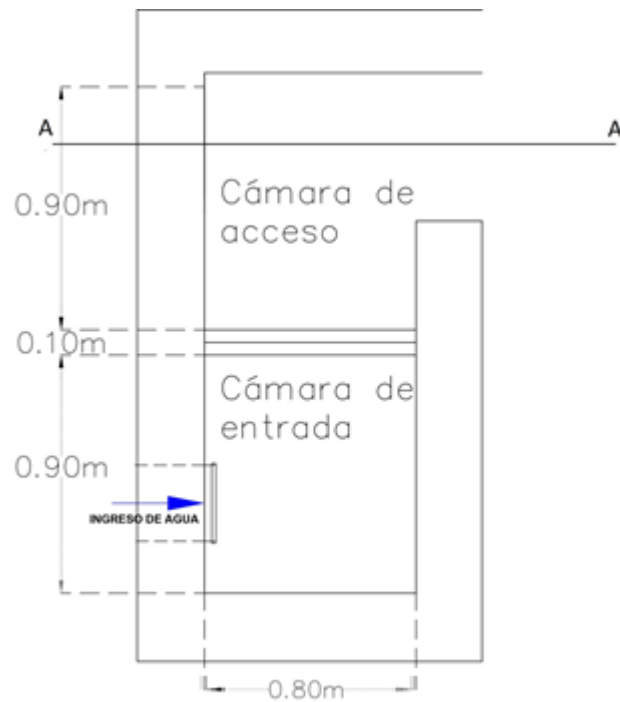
Dimensiones del diseño de la estructura en planta.
